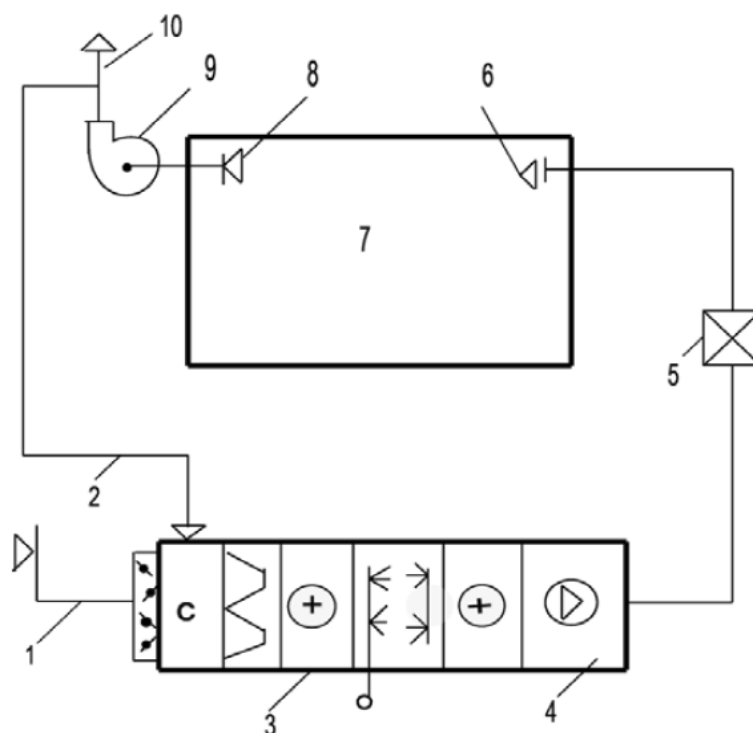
Принципиальная схема системы кондиционирования воздуха: 1 – воздухозаборное устройство; 2 – рециркуляционный воздухопровод; 3 – установка кондиционирования воздуха; 4 – приточный вентилятор; 5 – доводчик; 6 – система распределения воздуха; 7 – помещение; 8 – система удаления воздуха; 9 – вытяжной вентилятор; 10 – канал для выброса воздуха
